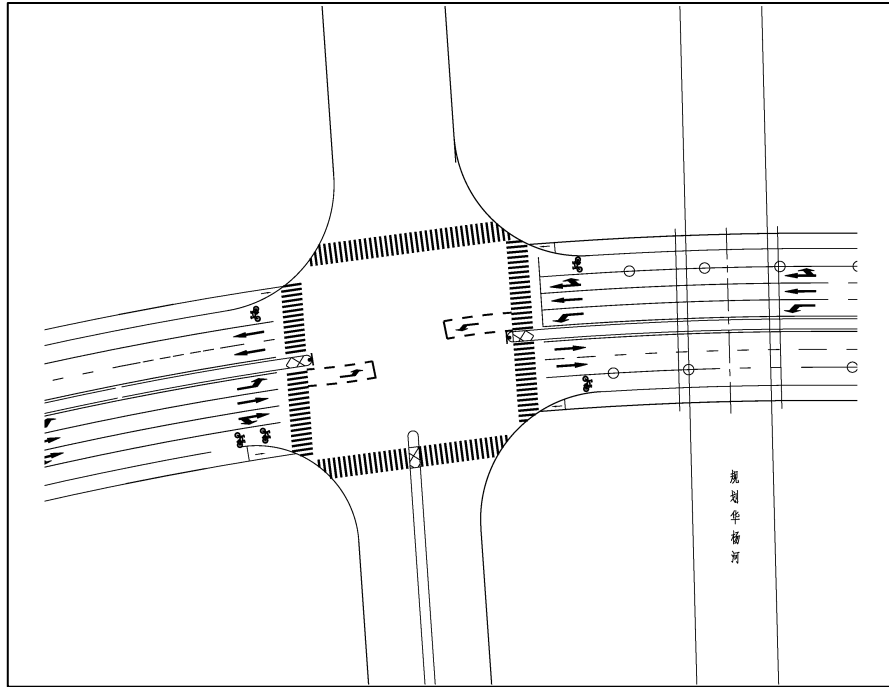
本项目与 G312 交叉口平面图（含规划华杨河）
